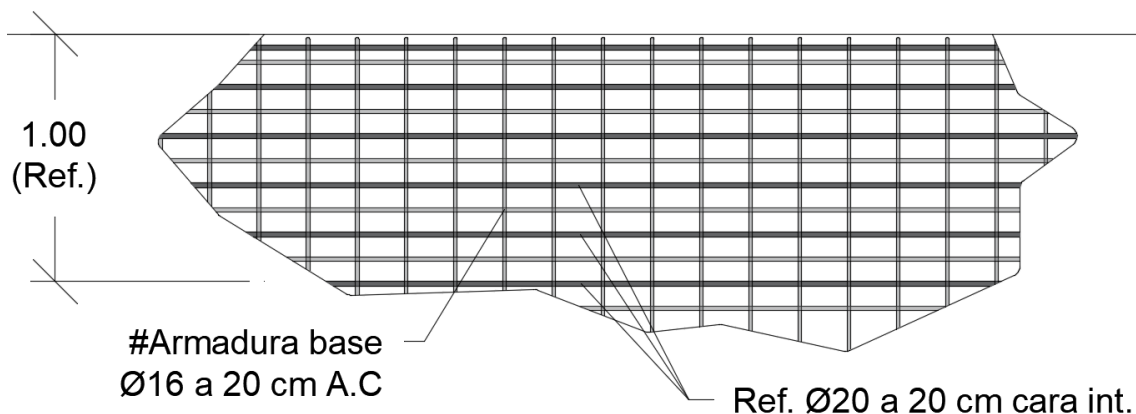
Refuerzo en muro externo 4 y 7 centro (armadura horizontal)
